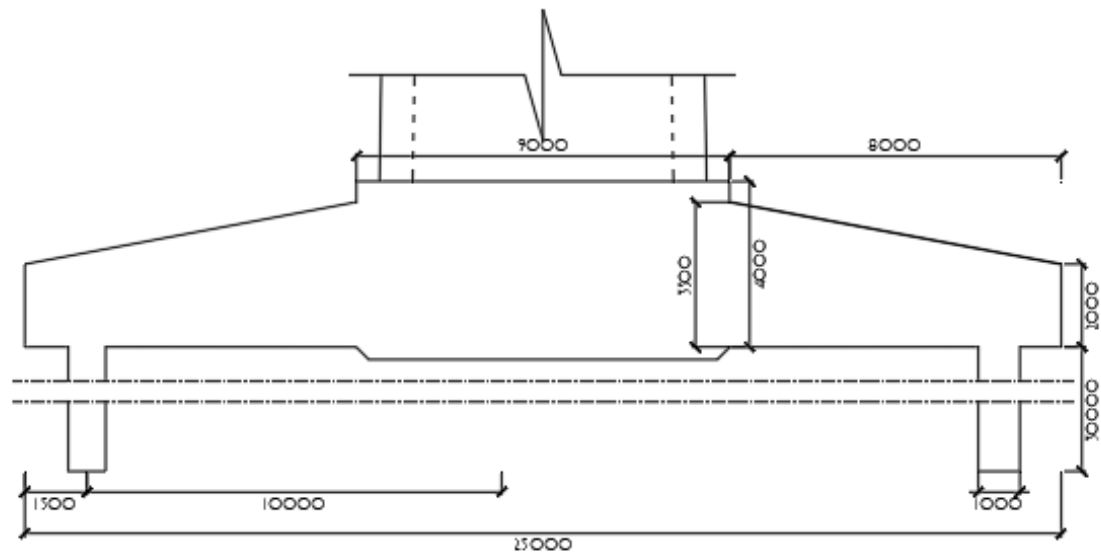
FONDAZIONE INDIRETTA - PLATEA E PALI IN SEZIONE E CARPENTERIA
